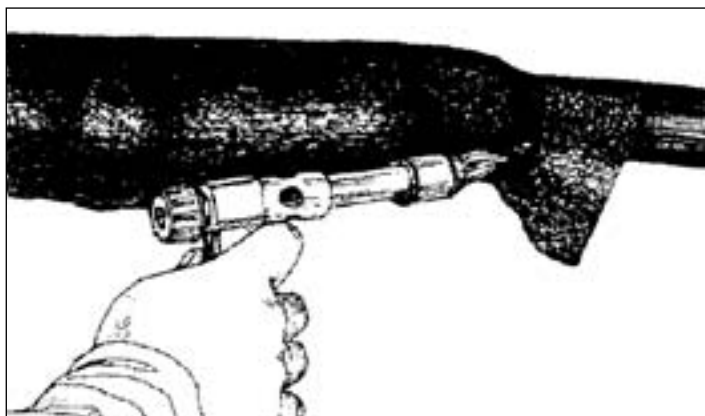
Усадка одной трубки ТУТ на свинцовую муфту
